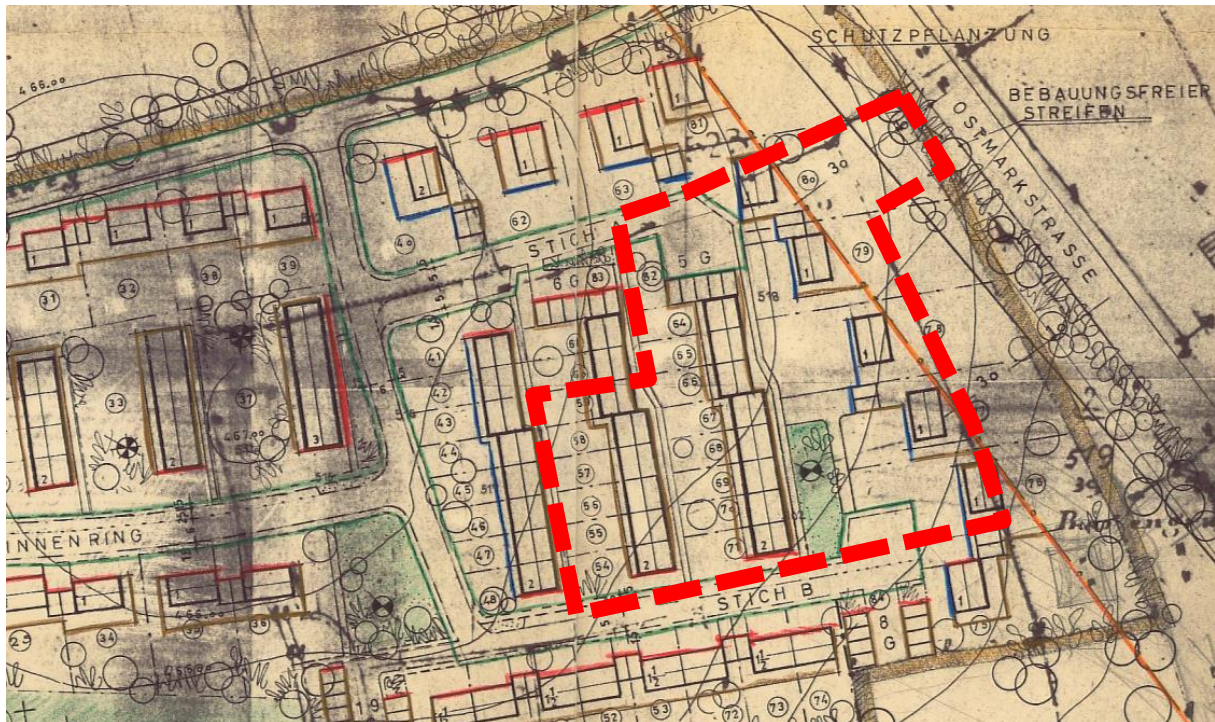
Auszug B-Plan „Rötz-Nord“ mit Lage der Änderungsflächen (rot umgrenzt), o.M.
